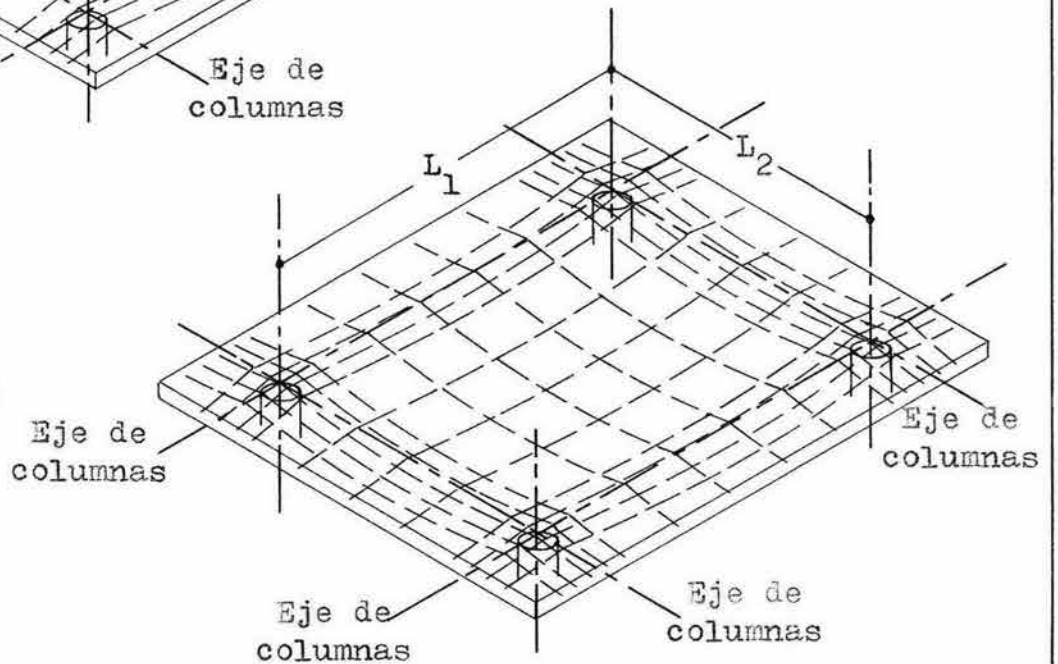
BALANCEO DE CARGA EN LOSA PLANA COMO UN SISTEMA DE VIGA ANCHA.
